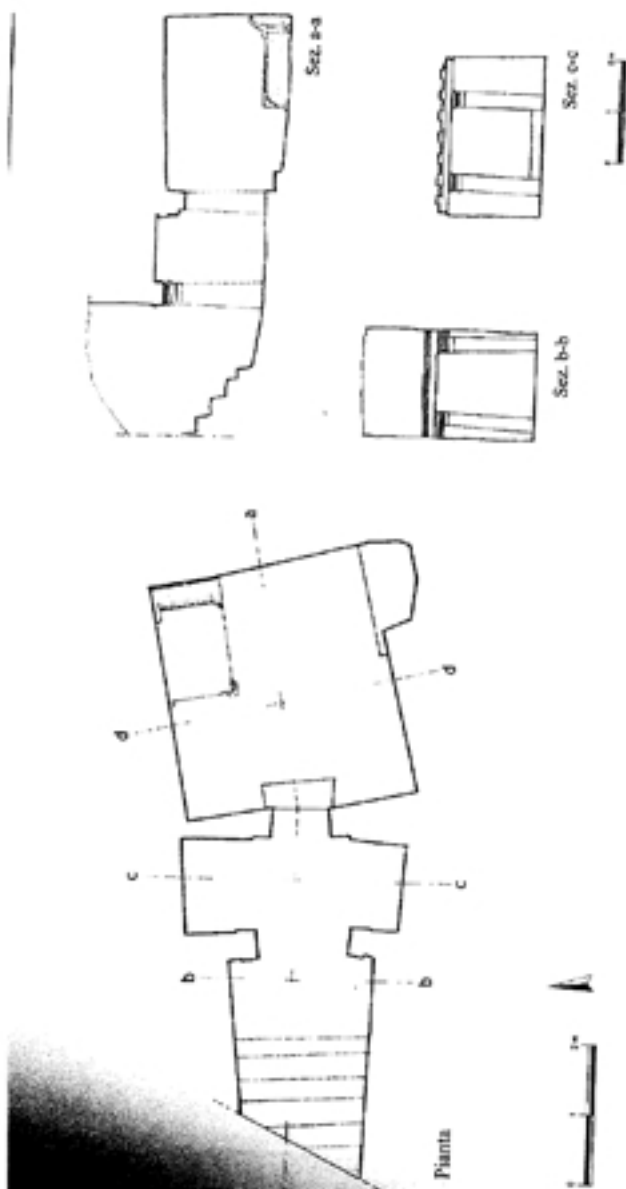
Ipogeo di Via Legnano. Pianta, sezione longitudinale e sezioni prospettiche.
